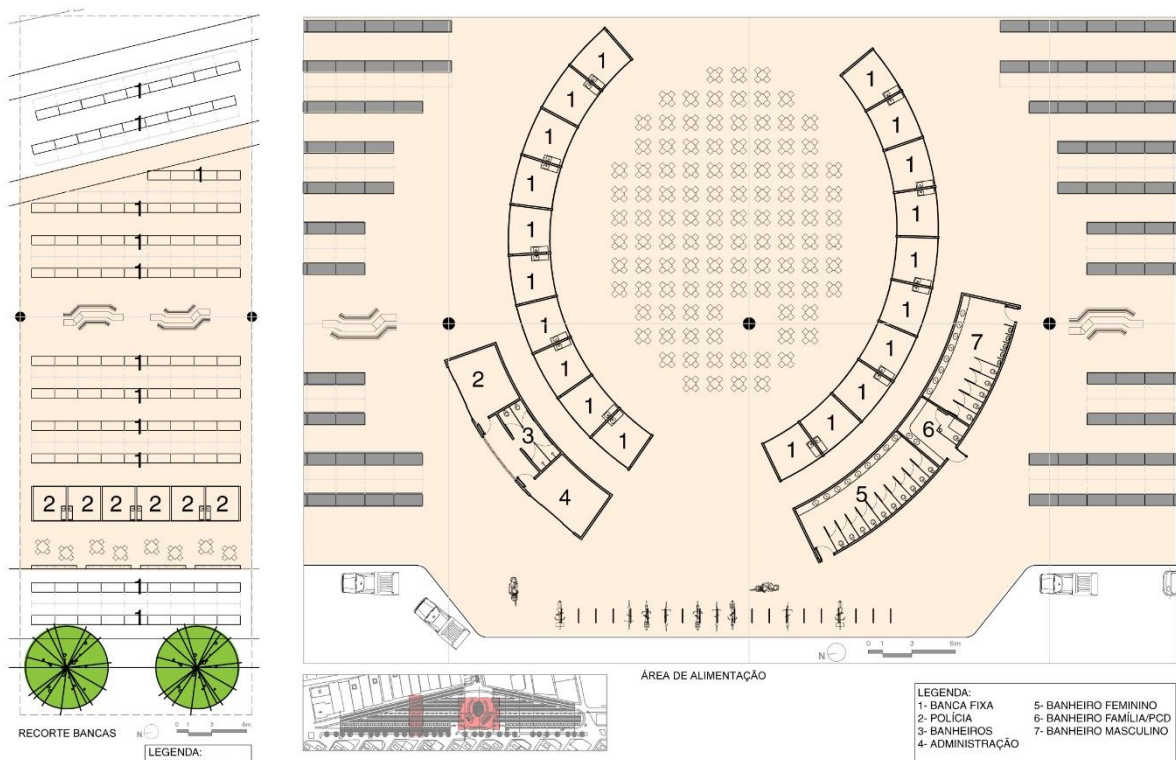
Detalhe centro. Fonte: Elaboração própria.
